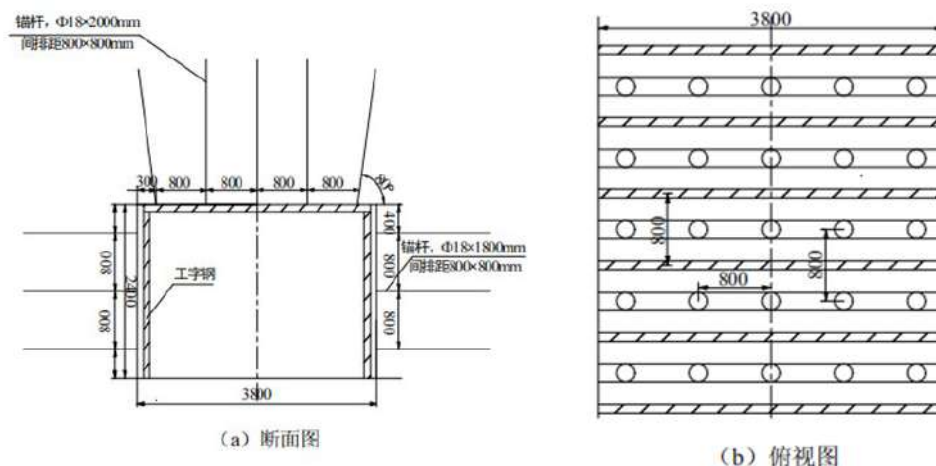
层间距小于 2~2.5m 巷道支护断面示意图
